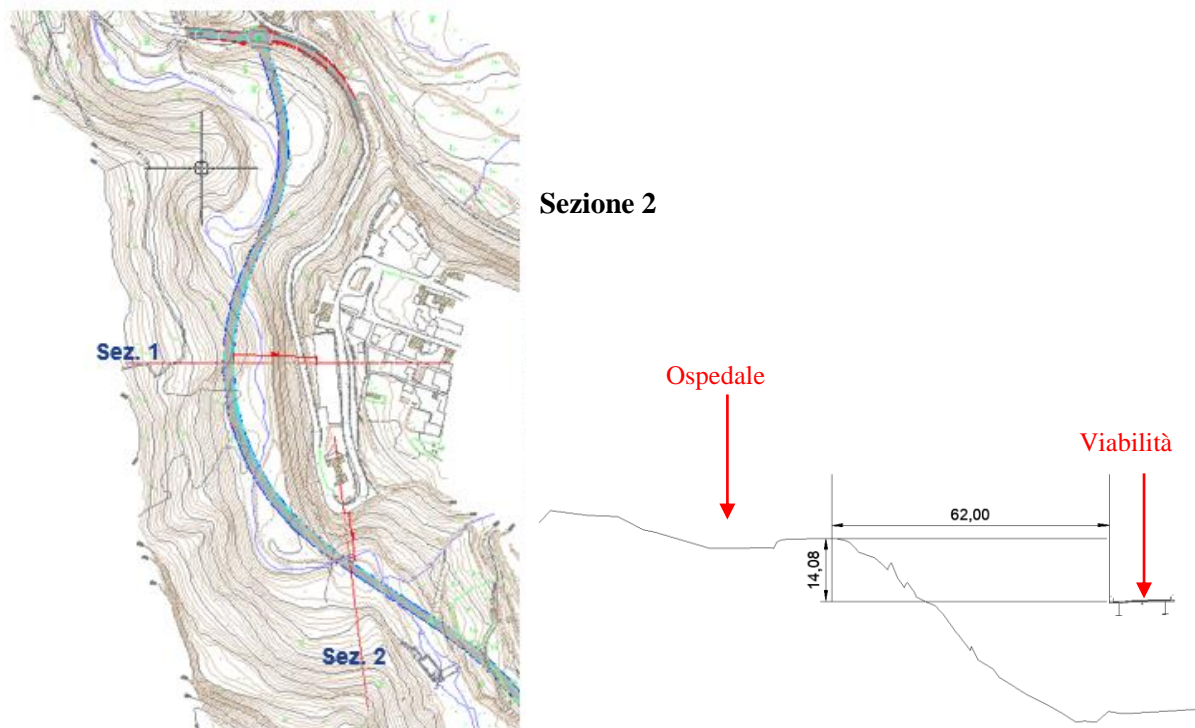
Traccia sezione e sezione 2: Ospedale – Viabilità in progetto
